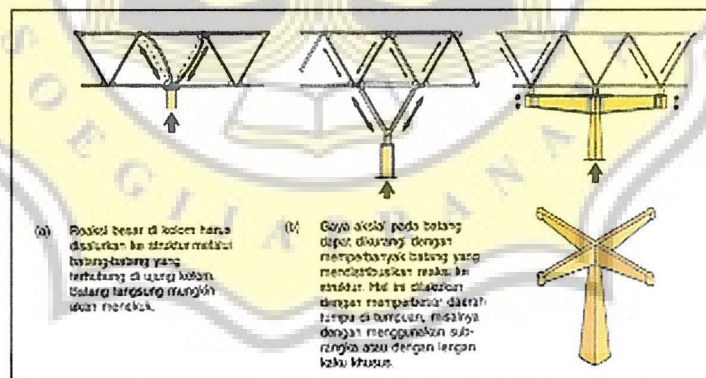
Elemen dasar pembentuk system rangka ruang
